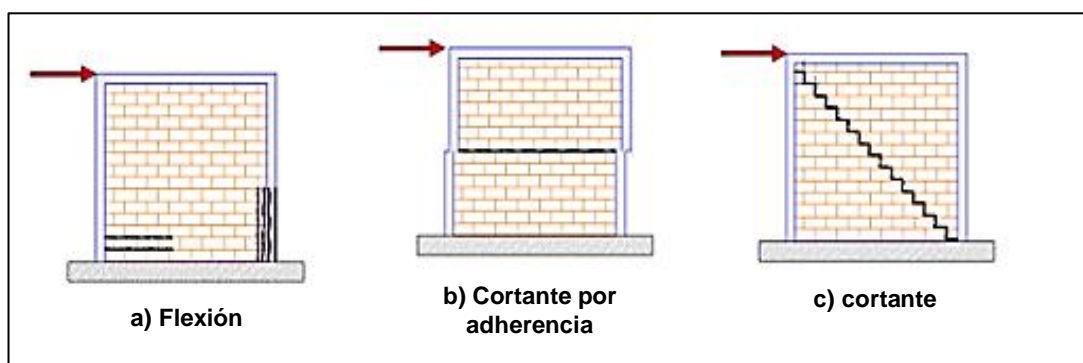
Causas de falla en los muros de albañilería armada (Se encuentra fallas por flexión, falla por cortante de adherencia y falla por corte)
